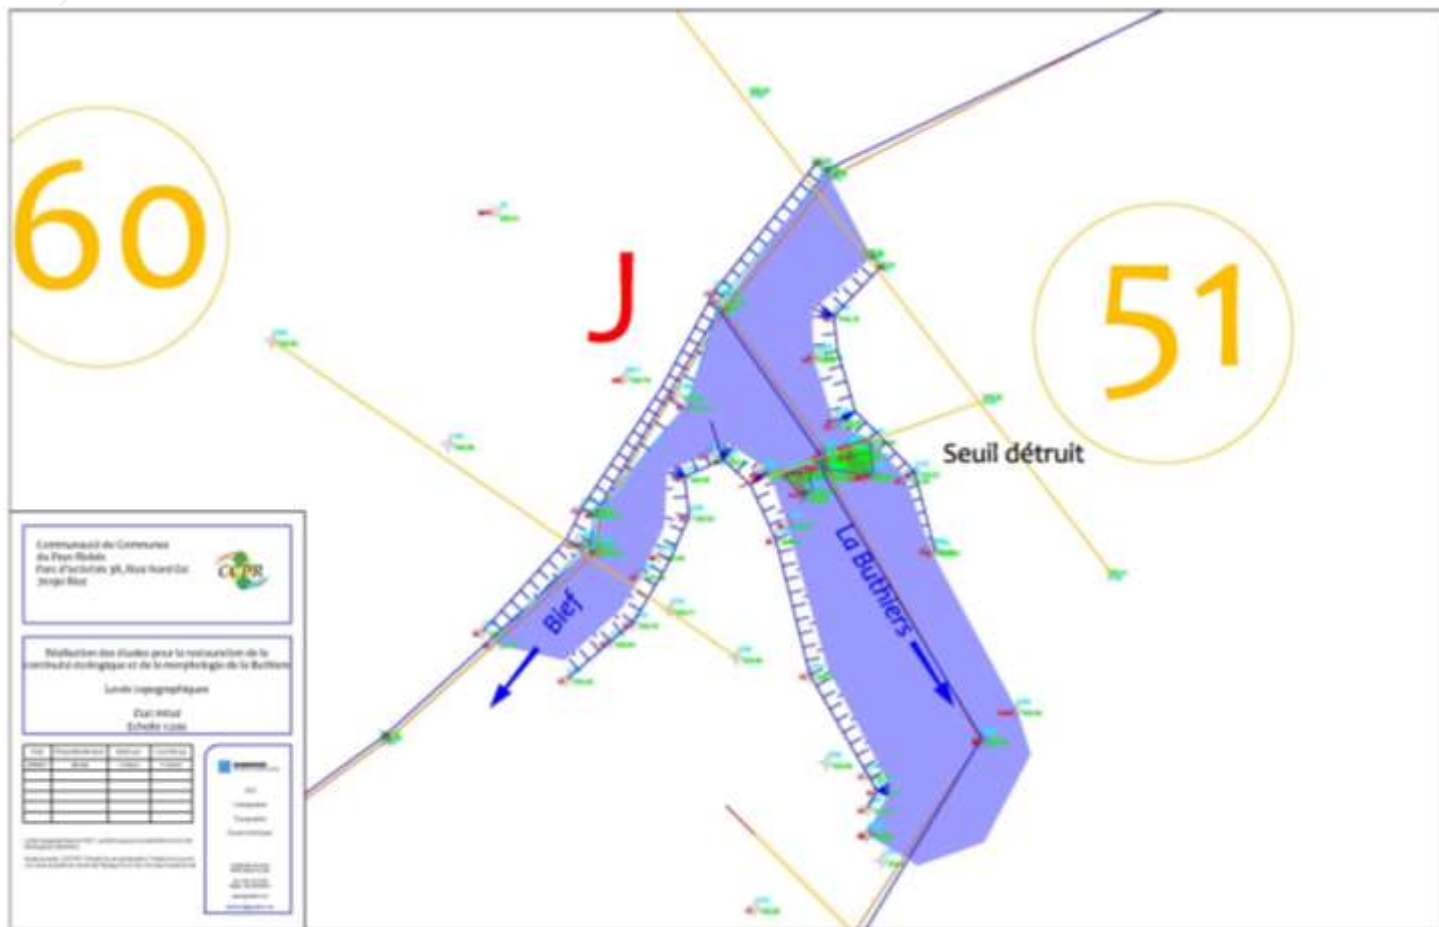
Plan topographique du moulin d'Avouay – Zoom sur le seuil
